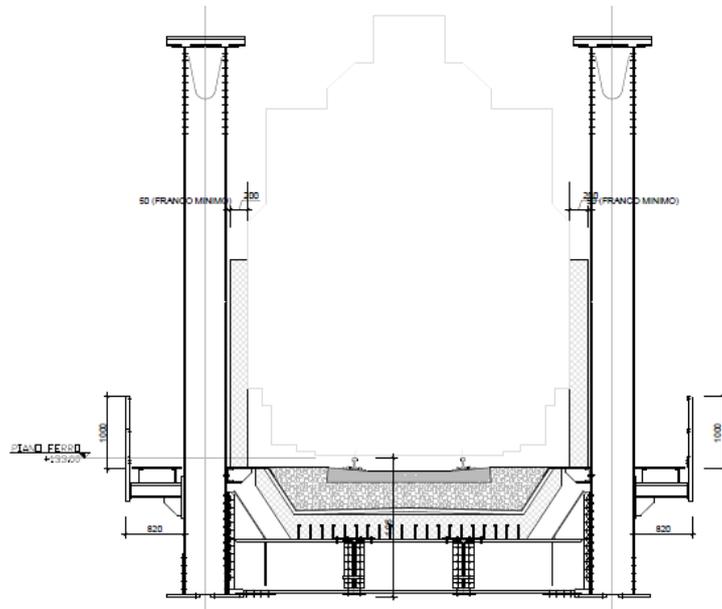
Sezione tipo impalcato del viadotto ferroviario VI01 (Luce=30-40 m)
